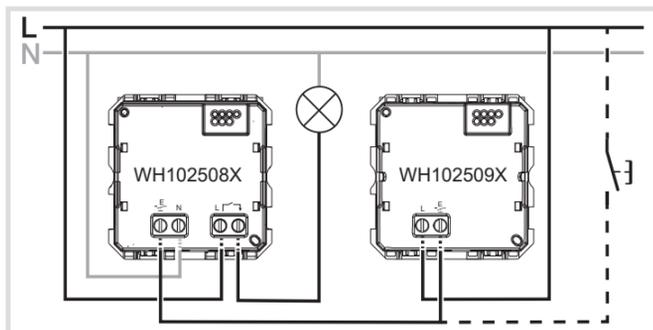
collegamento al rilevatore di movimento a 3 fili con pulsante di derivazione opzionale
